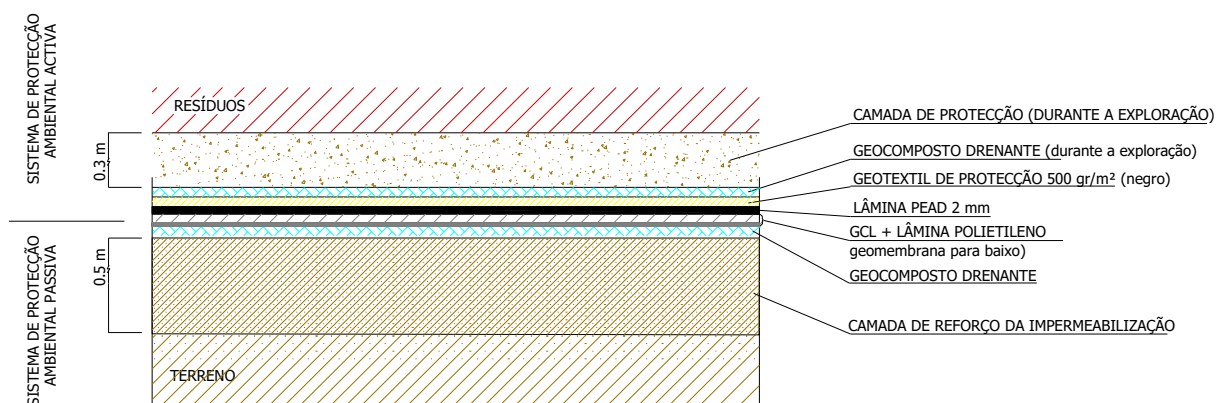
DETALHE DO PERFIL DE IMPERMEABILIZAÇÃO DOS TALUDES DA BACIA
